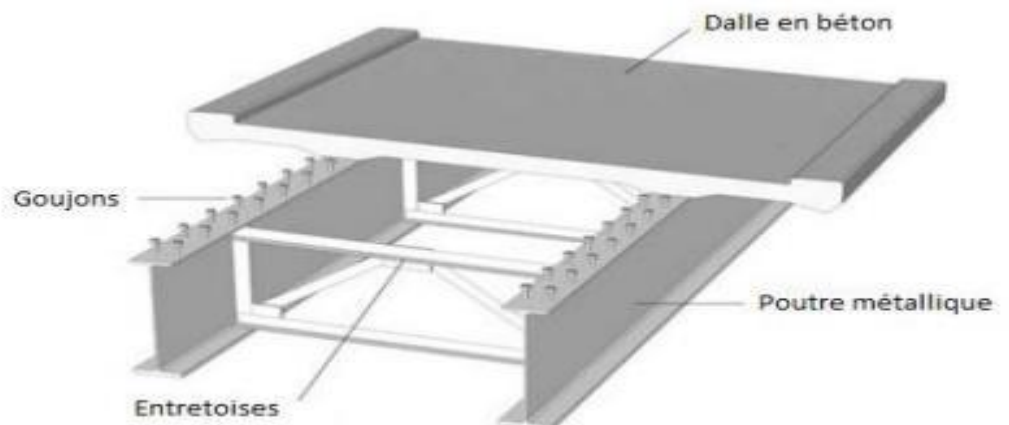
Principe de la dalle mixte avec une connexion par goujons
